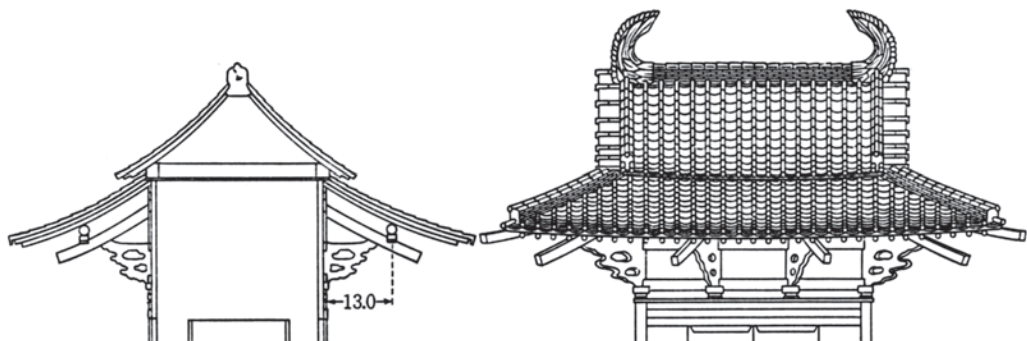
法隆寺玉虫厨子 部分立面・断面図 1:15
